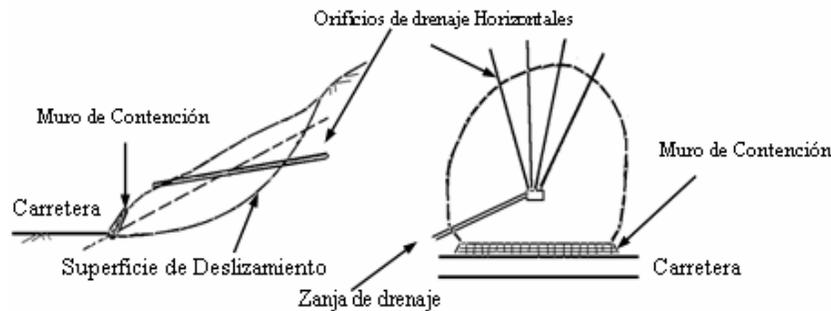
Ubicación Típica de los Orificios de Drenaje Horizontales
